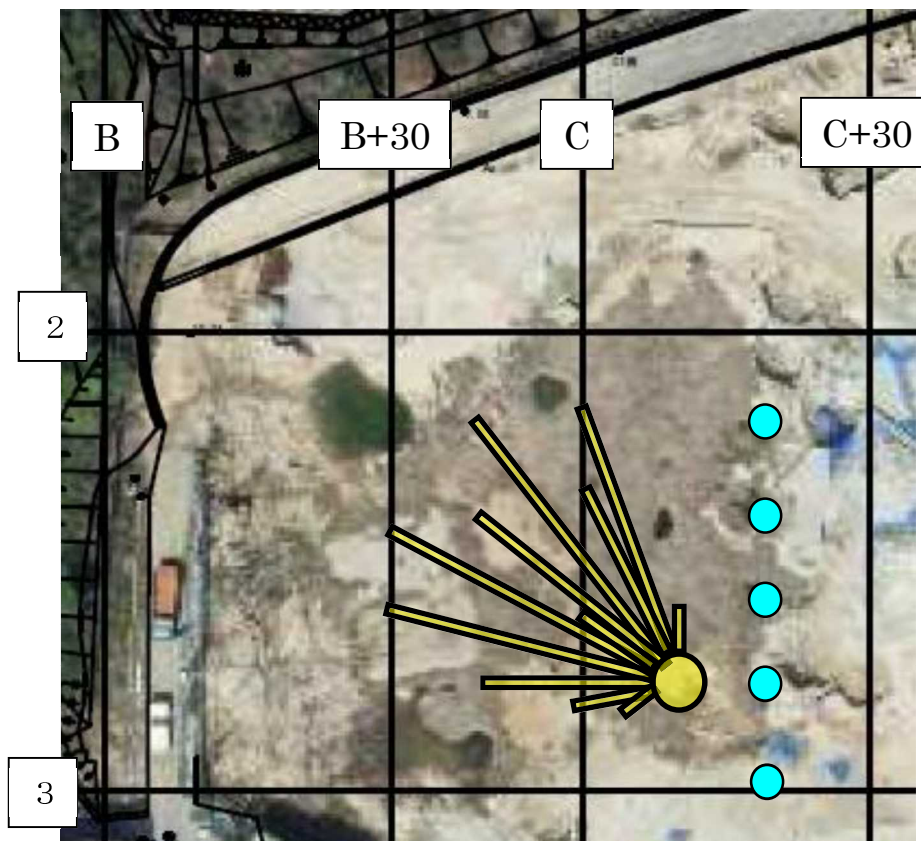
平面図（集水井、集水ボーリング及び詳細な調査位置）
